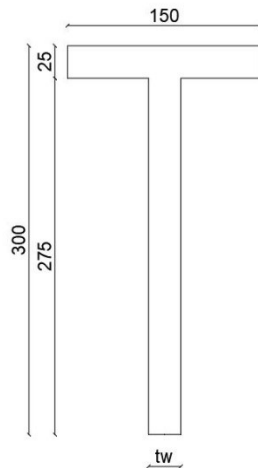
Sezione tipo della trave a T (misure in mm)
